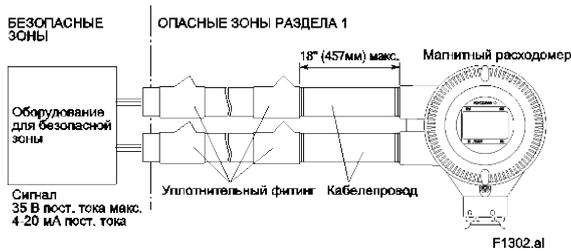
Прокладка электропроводки в кабелепроводе
